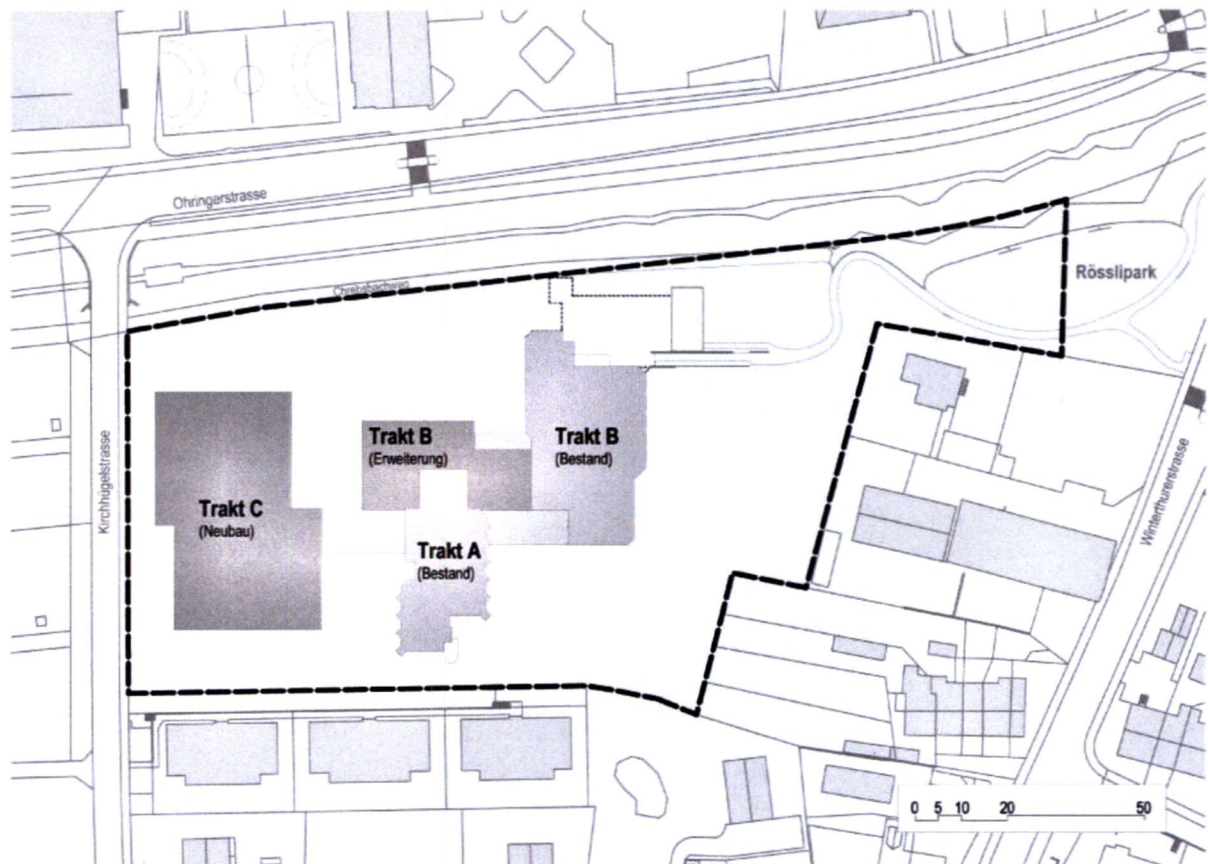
Situationsplan Gestaltungsplanperimeter GP AZiG, Mst. 1:1500 (Quelle: BGP Architekten)
